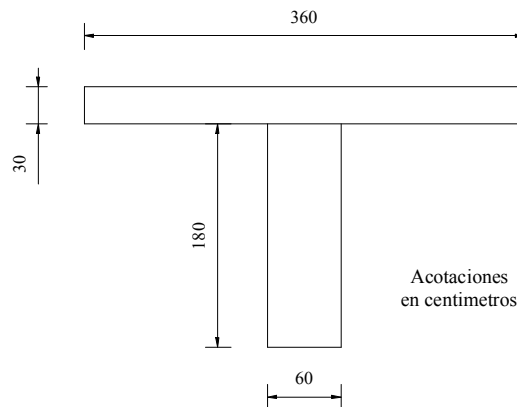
SECCIÓN TRANSVERSAL DE LA CIMENTACIÓN
